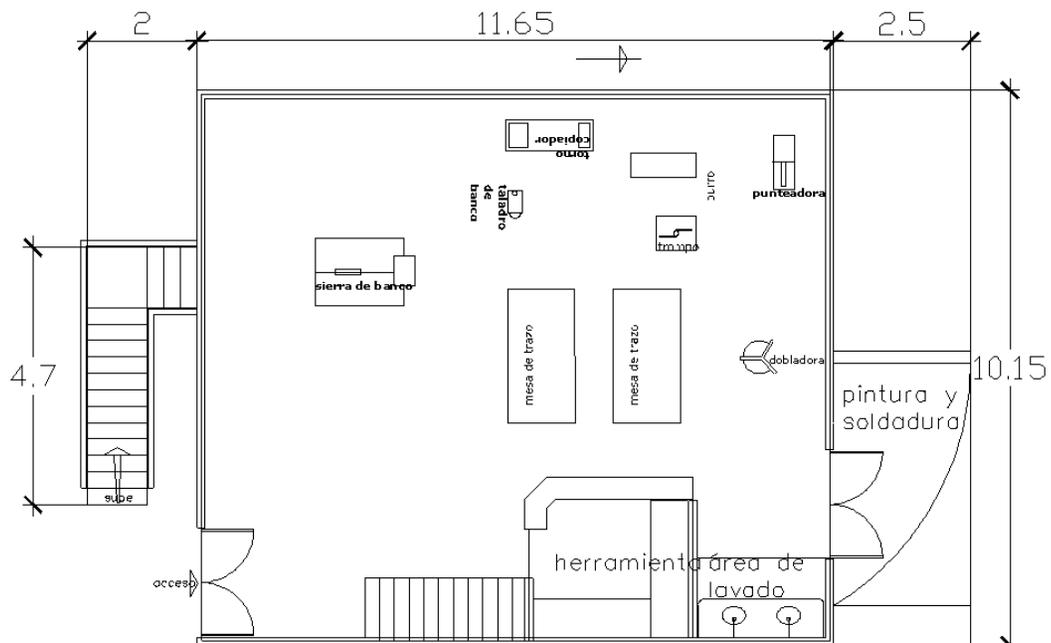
Distribución de la planta baja sin áreas de trabajo (taller carpintería-herrería).
